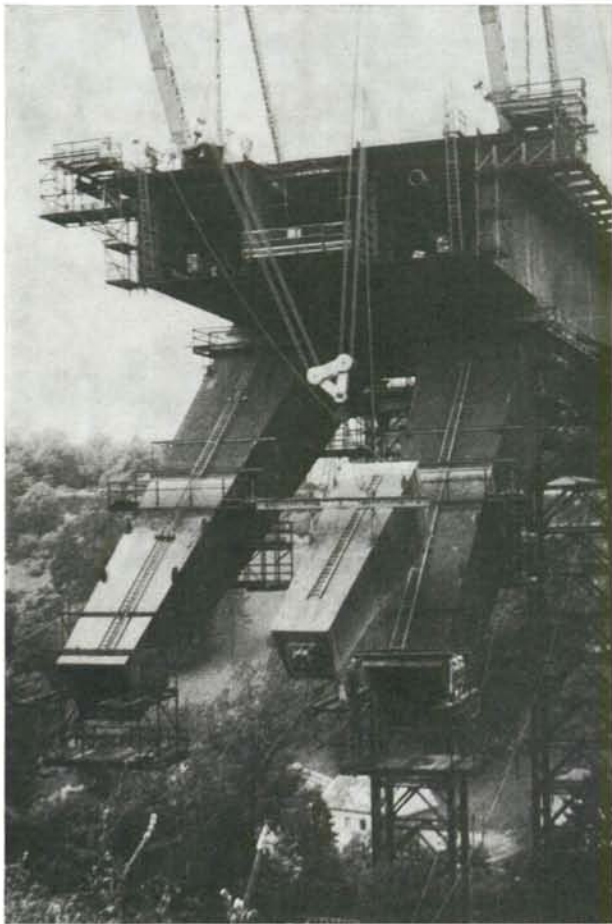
Montage d'un pied de béquille côté Kirchberg
